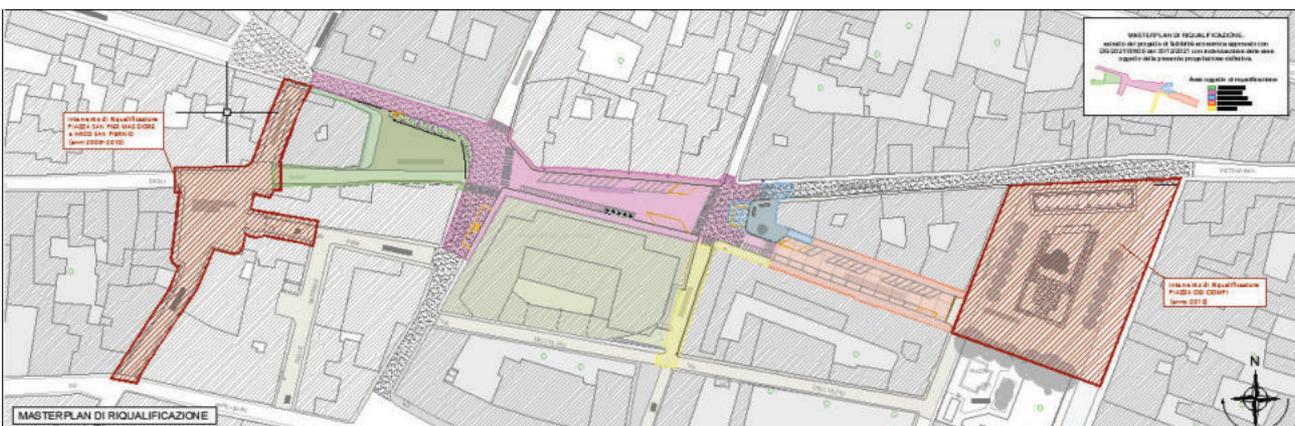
Suddivisione in aree funzionali e collegamento con piazza Ciampi/San Pier Maggiore
